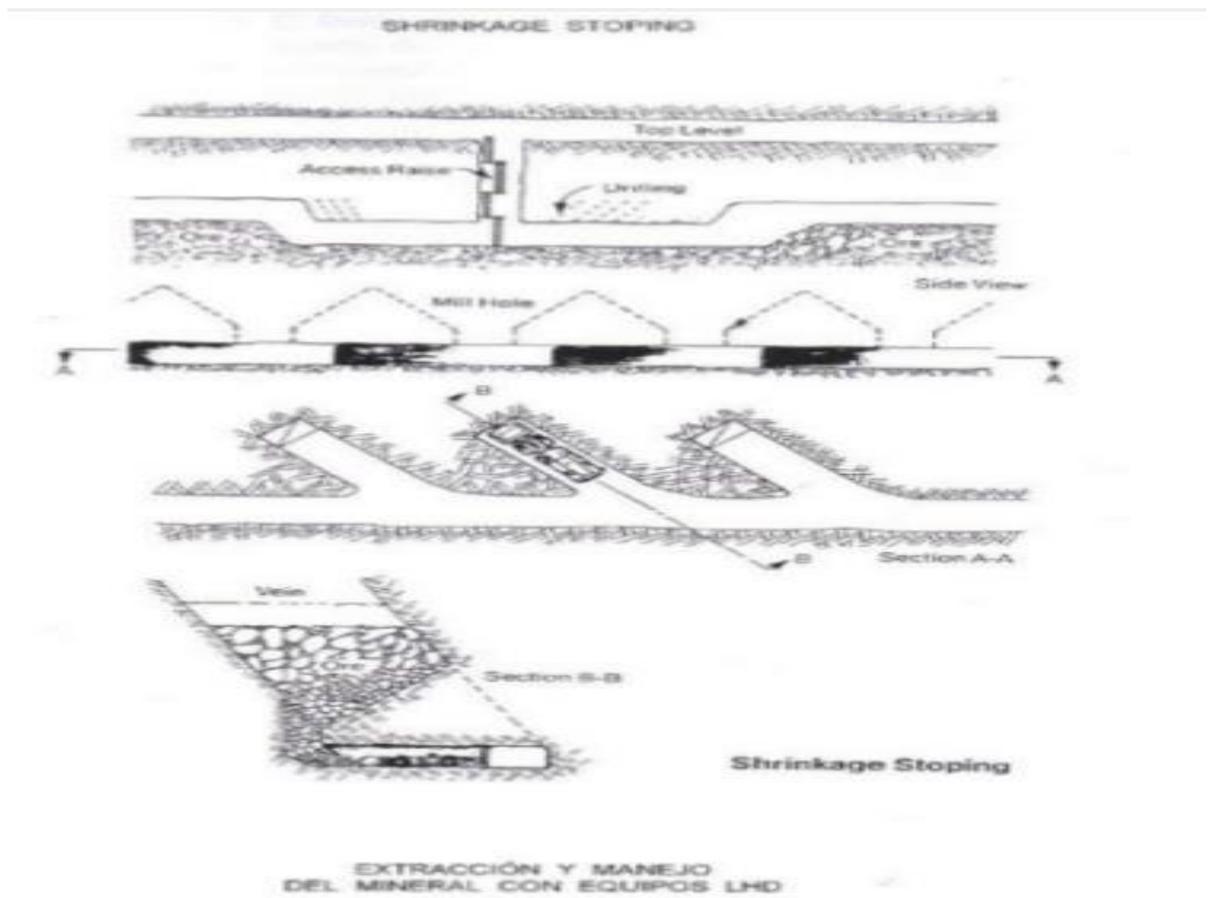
Shrinkage Stopping - Fuente Planeamiento Mina Casapalca.
